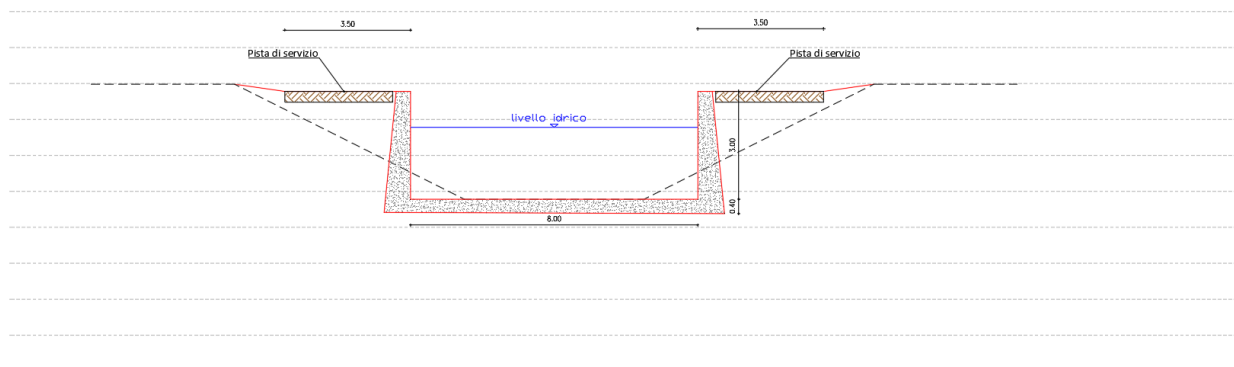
Sezione tipologica del tratto di attraversamento del viadotto di progetto di via Portogallo.
